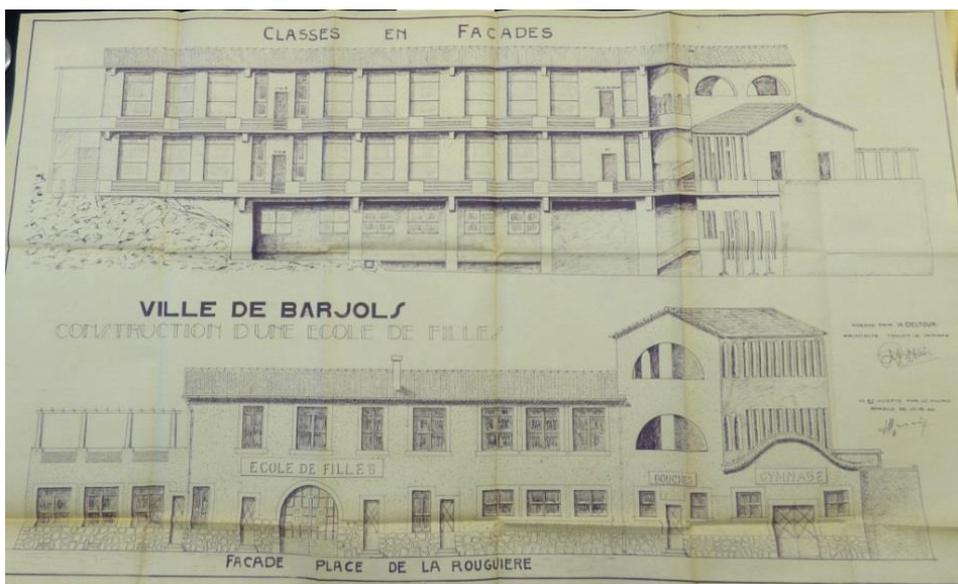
Construction d'une école de filles, classes en façades et façade place de la Rouguière, Henri Deltour (architecte).
